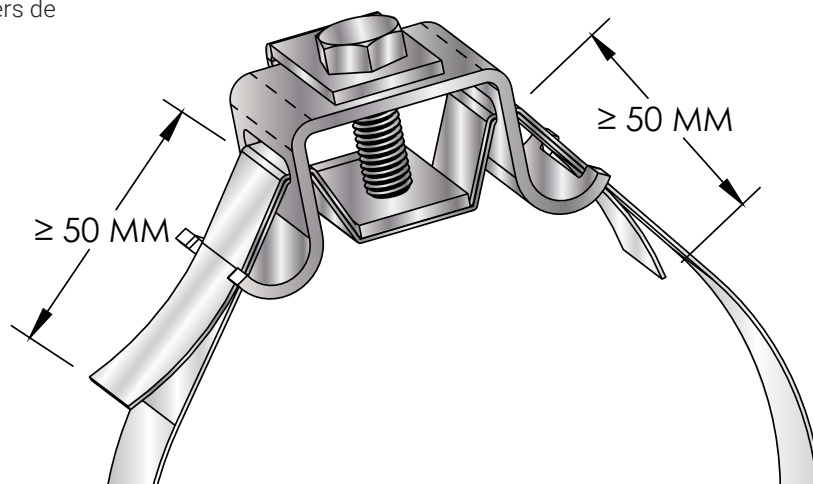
Dépassement des extrémités de la sangle dans le collier de serrage
